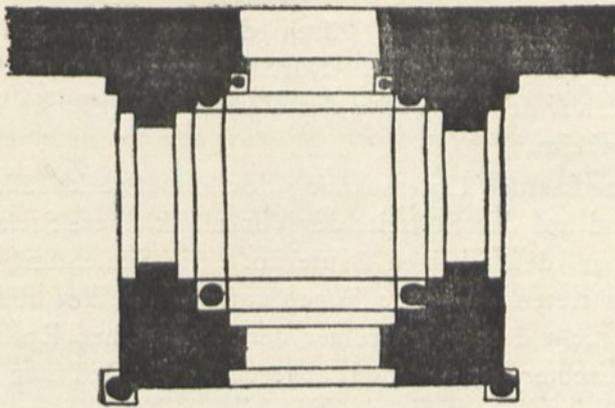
Grundriß der Vorhalle (rekonstruiert).
